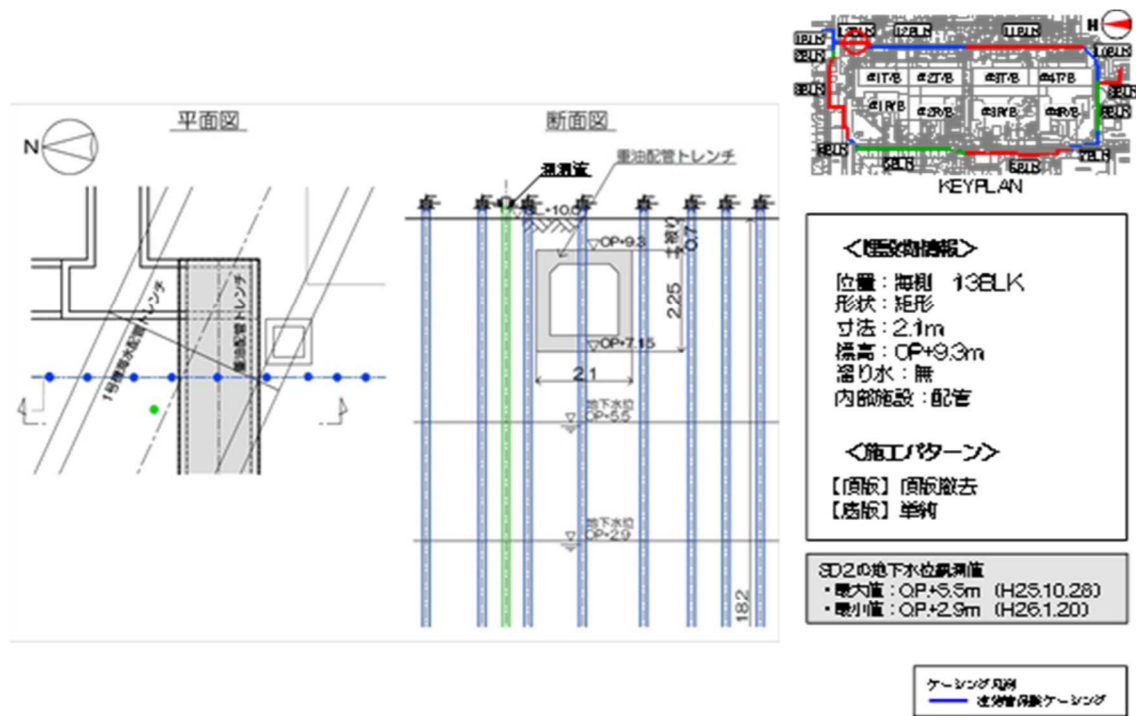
【12-10】1号機取水電源ケーブル管路 施工方法 (貫通施工)
